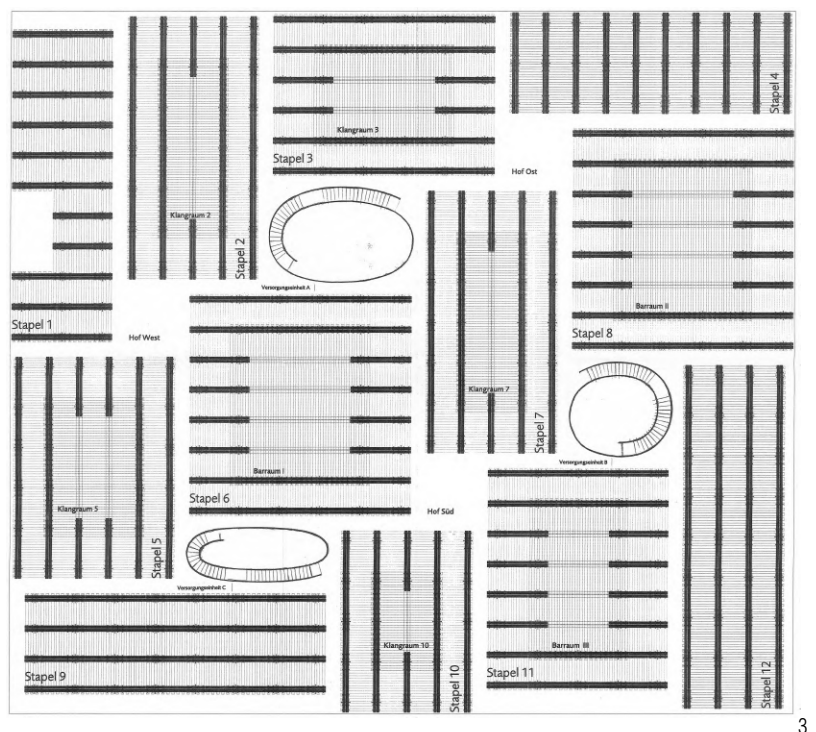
Peter Zumthor, planta arquitectónica primera propuesta de Batterie (1996)
